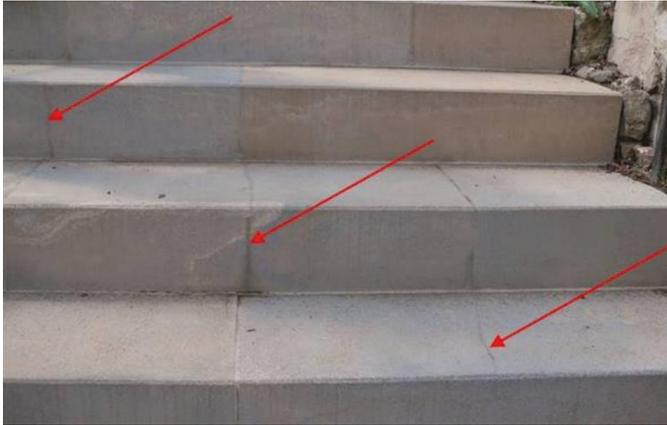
Risse in Betonstufen (Quelle: Betonverband SLG)
